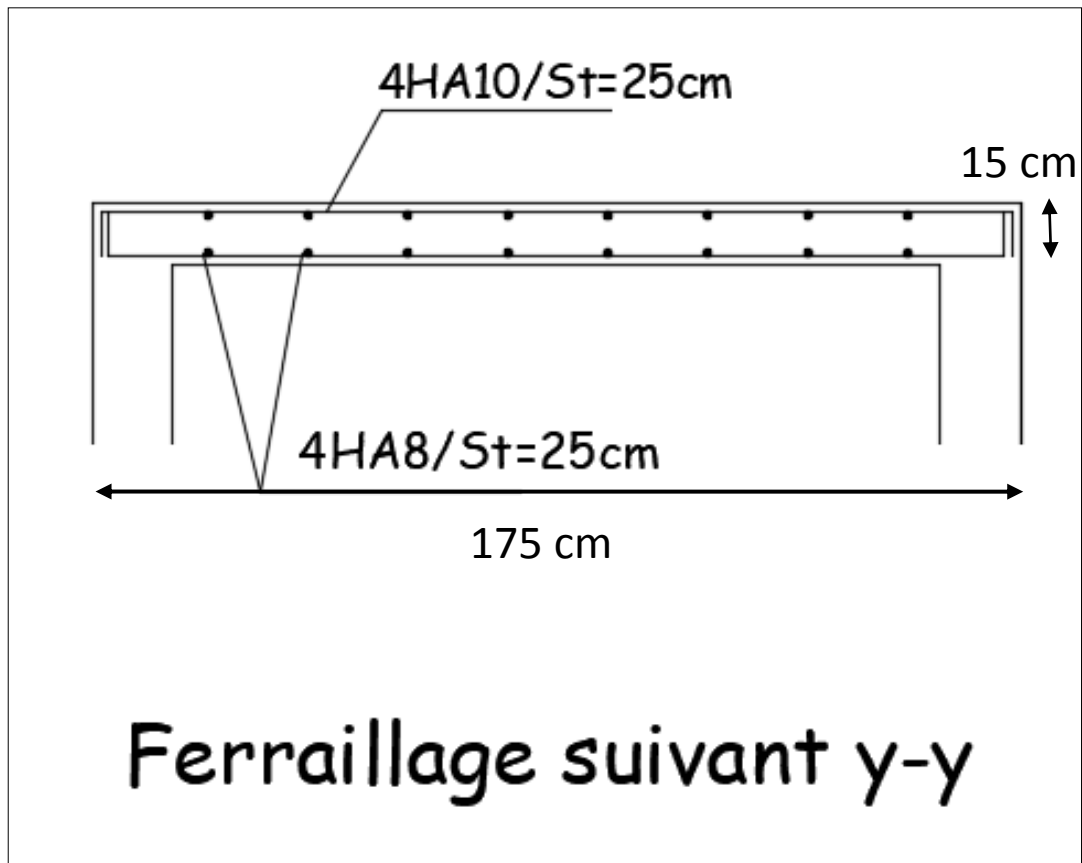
Ferrailage de la dalle pleine de la salle machine
